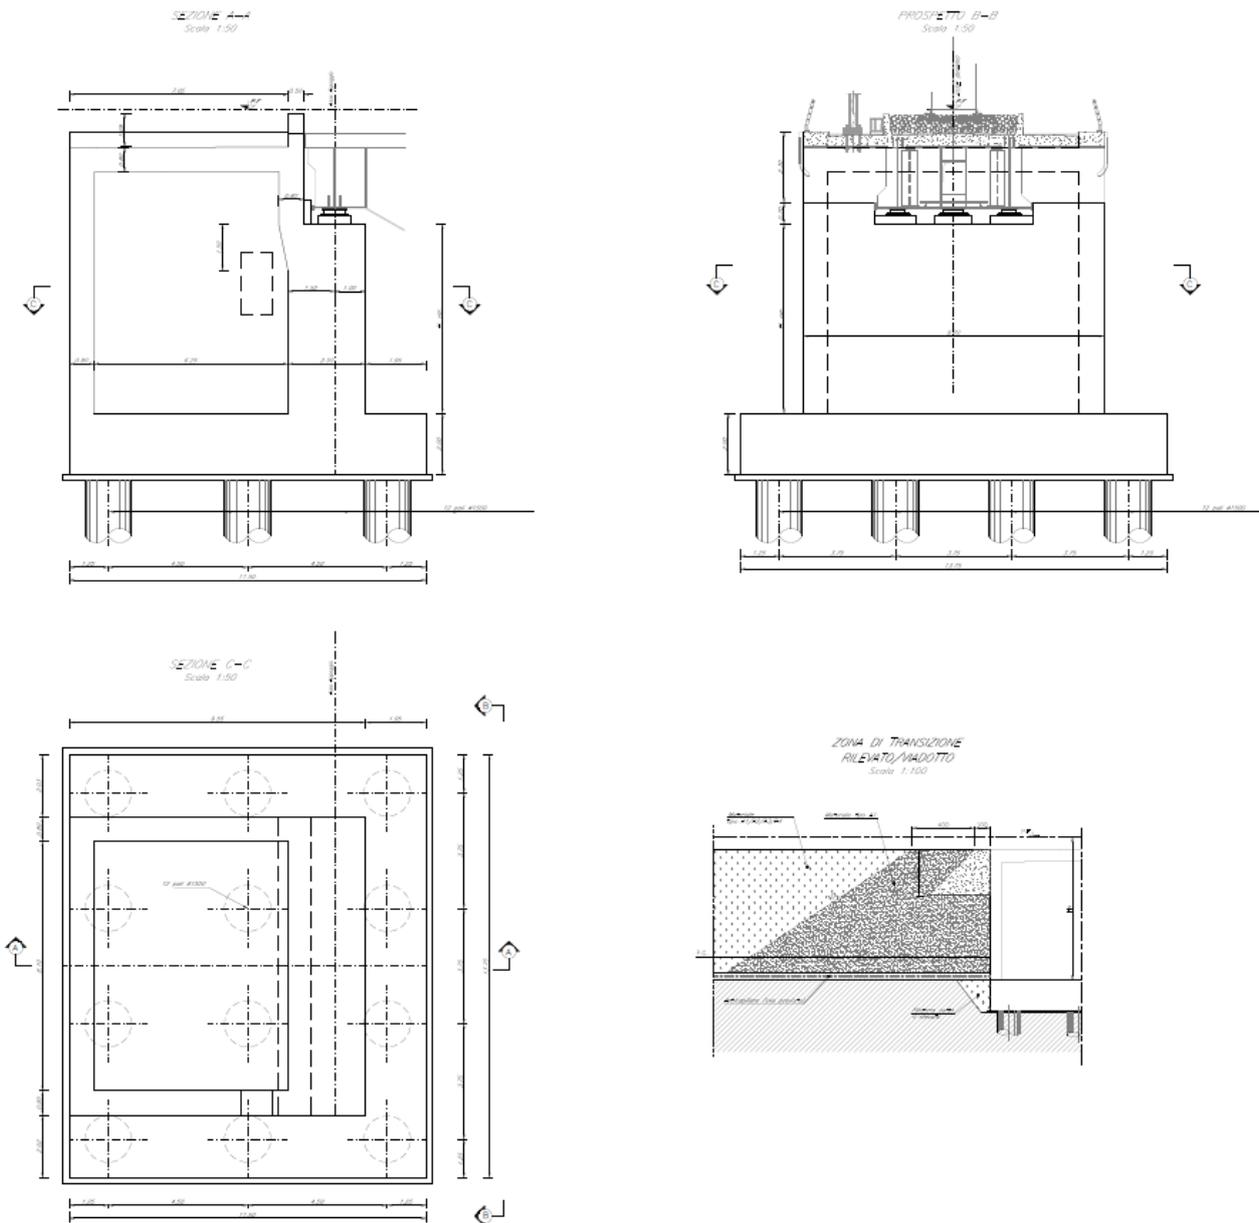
Carpenteria Spalla Campata L=45.00 m
